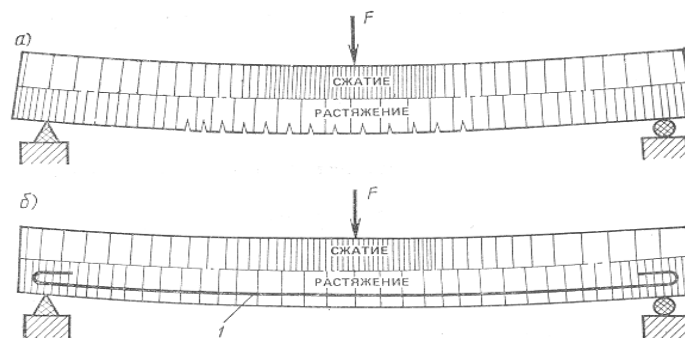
Неармированная бетонная (а) и армированная железобетонная (б) балки;
